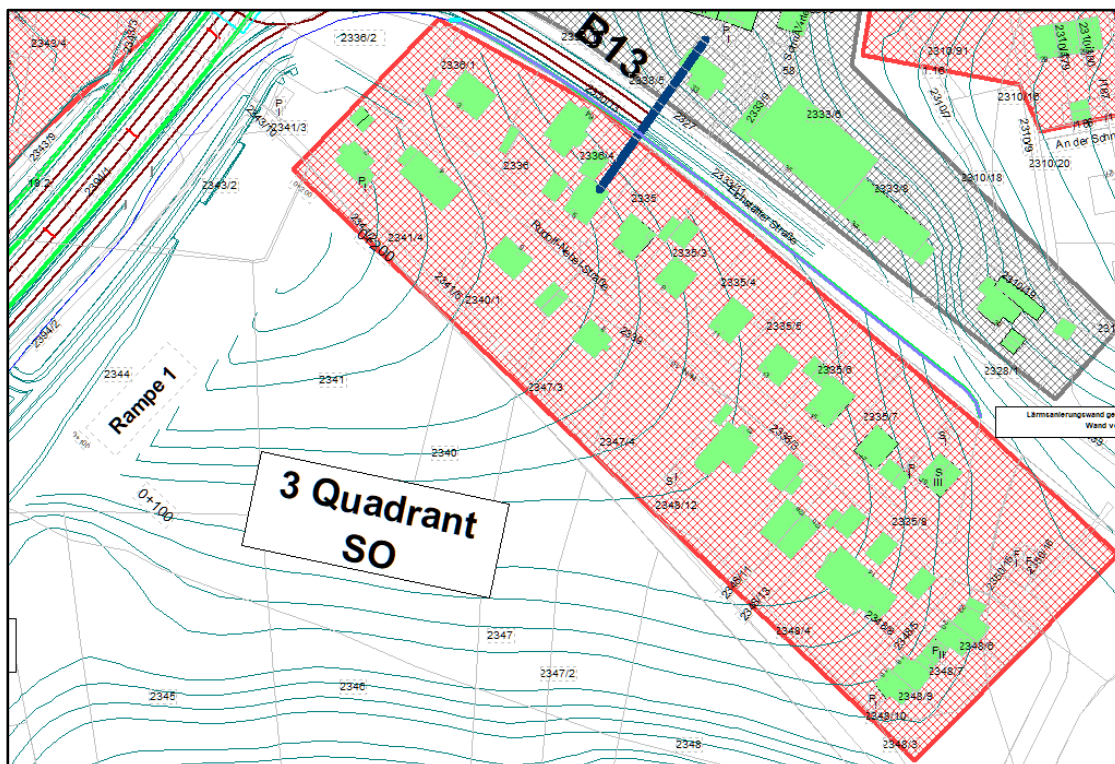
Lageplanskizze 3. Quadrant (SO)
